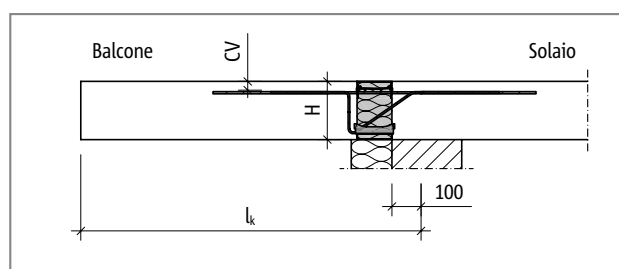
Schöck Isokorb® tipo KXT: schema statico
